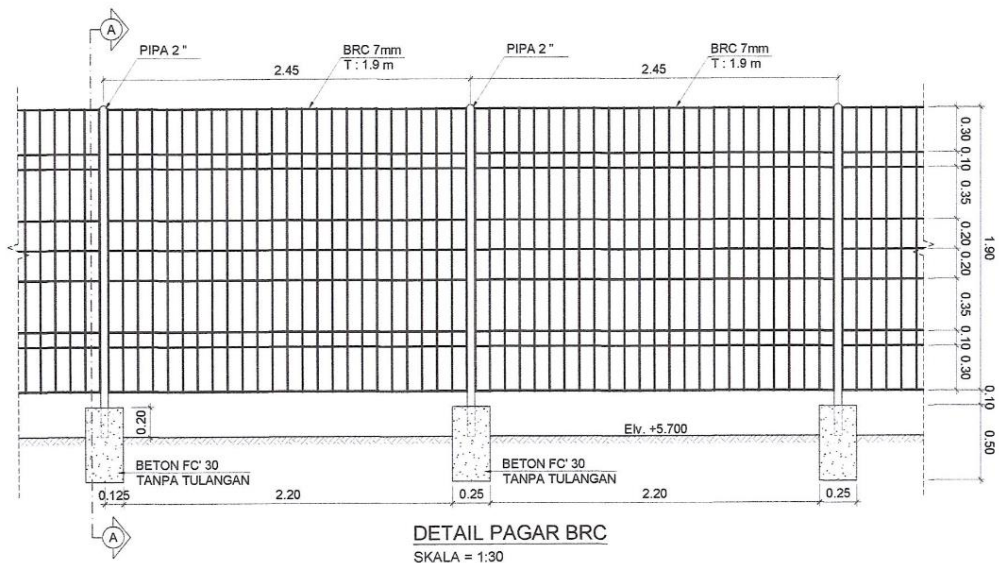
Layout Rencana Pemasangan Pagar BRC Tipe 190
